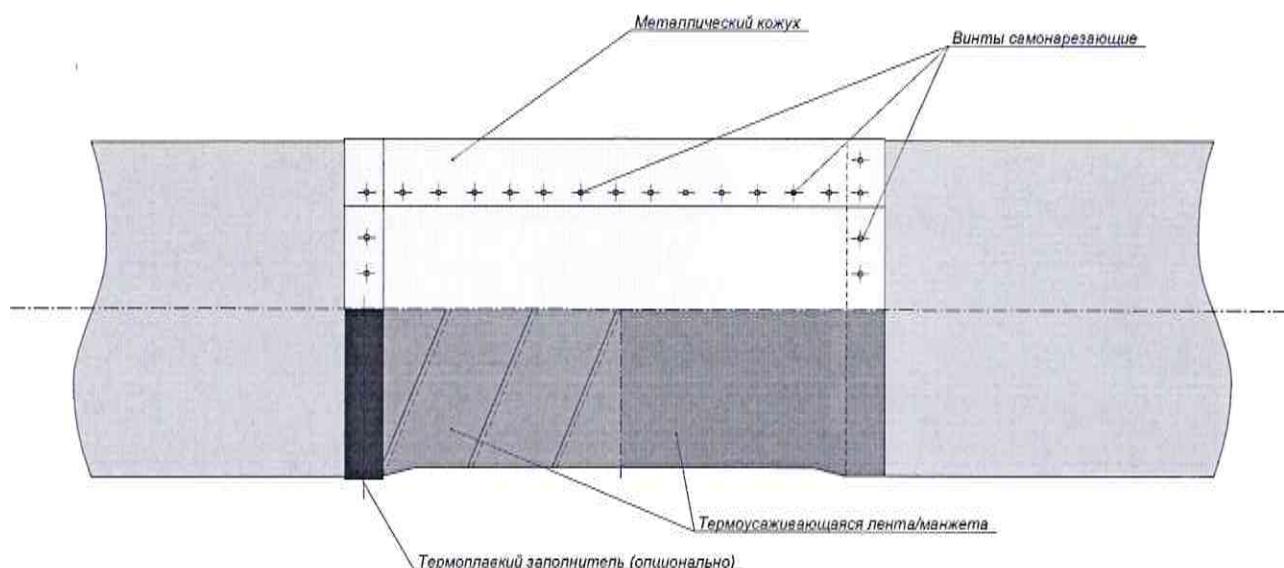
Крепление кожуха для теплогидроизоляции сварного стыка труб
